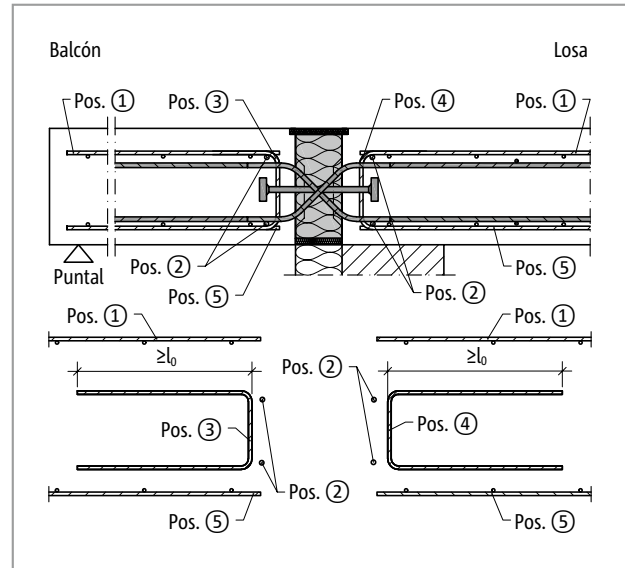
Schöck Isokorb® T tipo Q-P-VV: Armadura in situ
